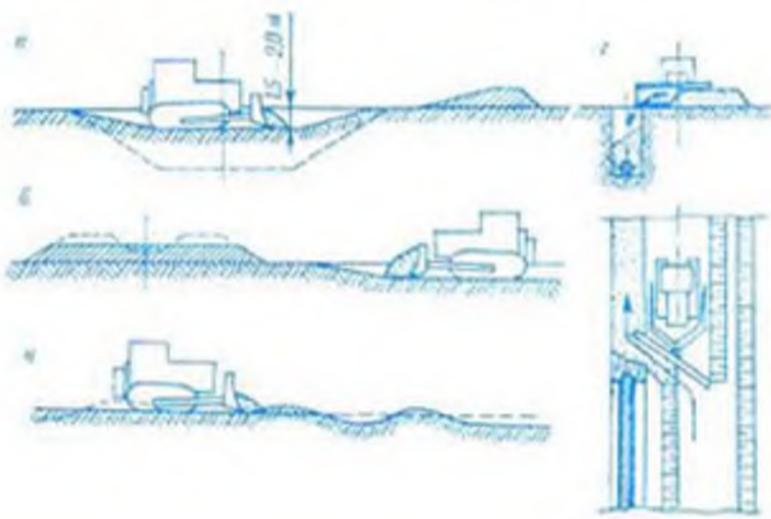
Разработка грунта бульдозерами с неповоротным и поворотным отвалами в гидромелиоративном строительстве: а — поперечная разработка верхнего слоя выемки канала; б — отсыпка подушек для каналов из бочковых резервов; в — планировка поверхности грунта; г — засыпка траншей при продольных ходах универсального бульдозера.
